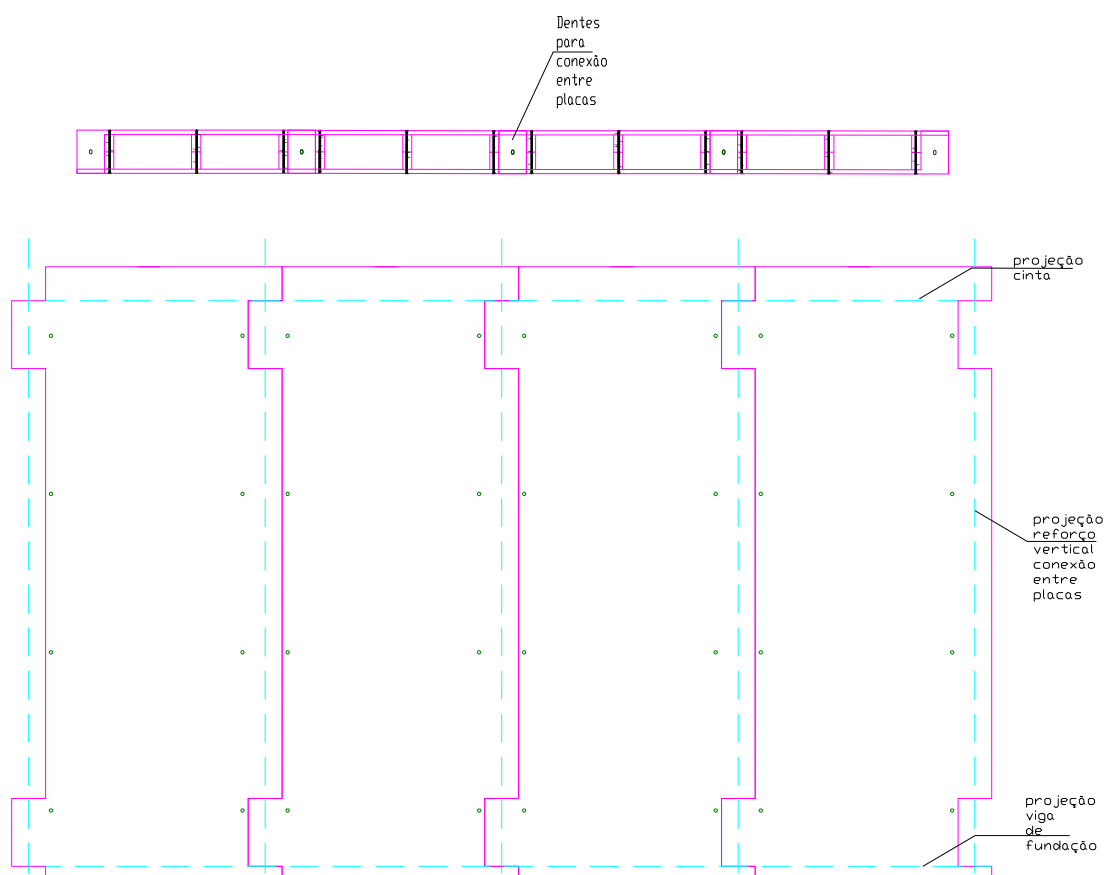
Conexão dos painéis referente à terceira alternativa de sistema construtivo.
